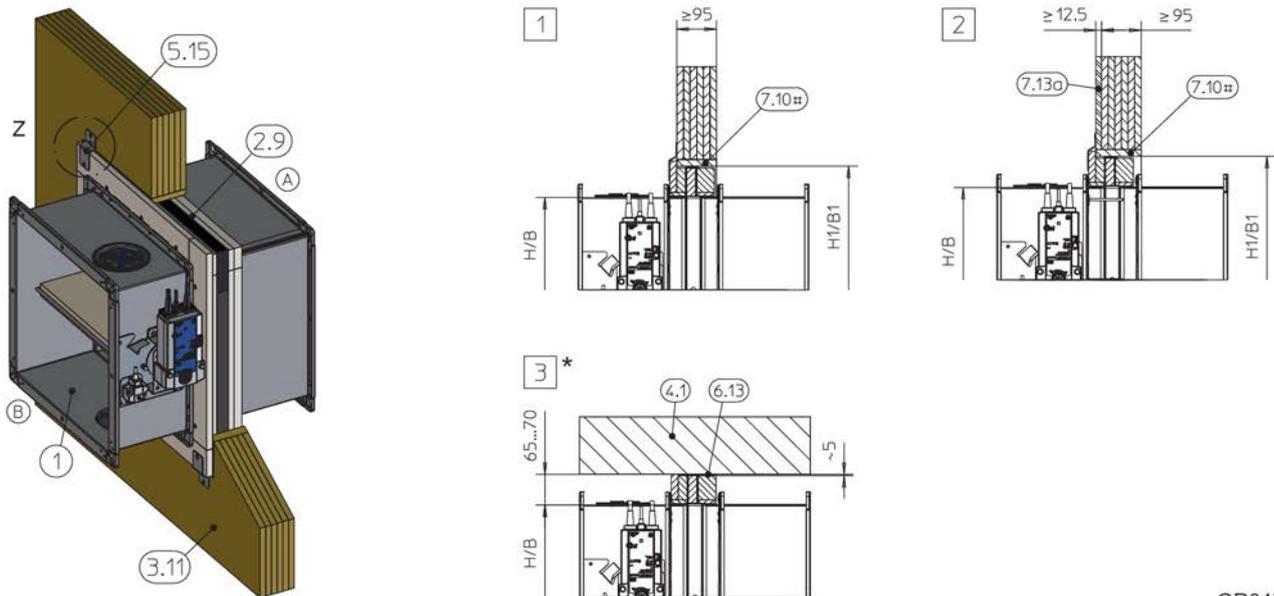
Instalación con mortero en pared de madera maciza o pared CLT
